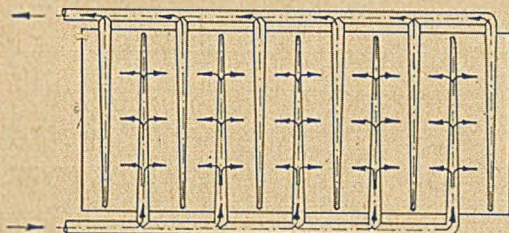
Grundriß über die Führung der Heizluftkanäle innerhalb der Decke nach Bild 134.
